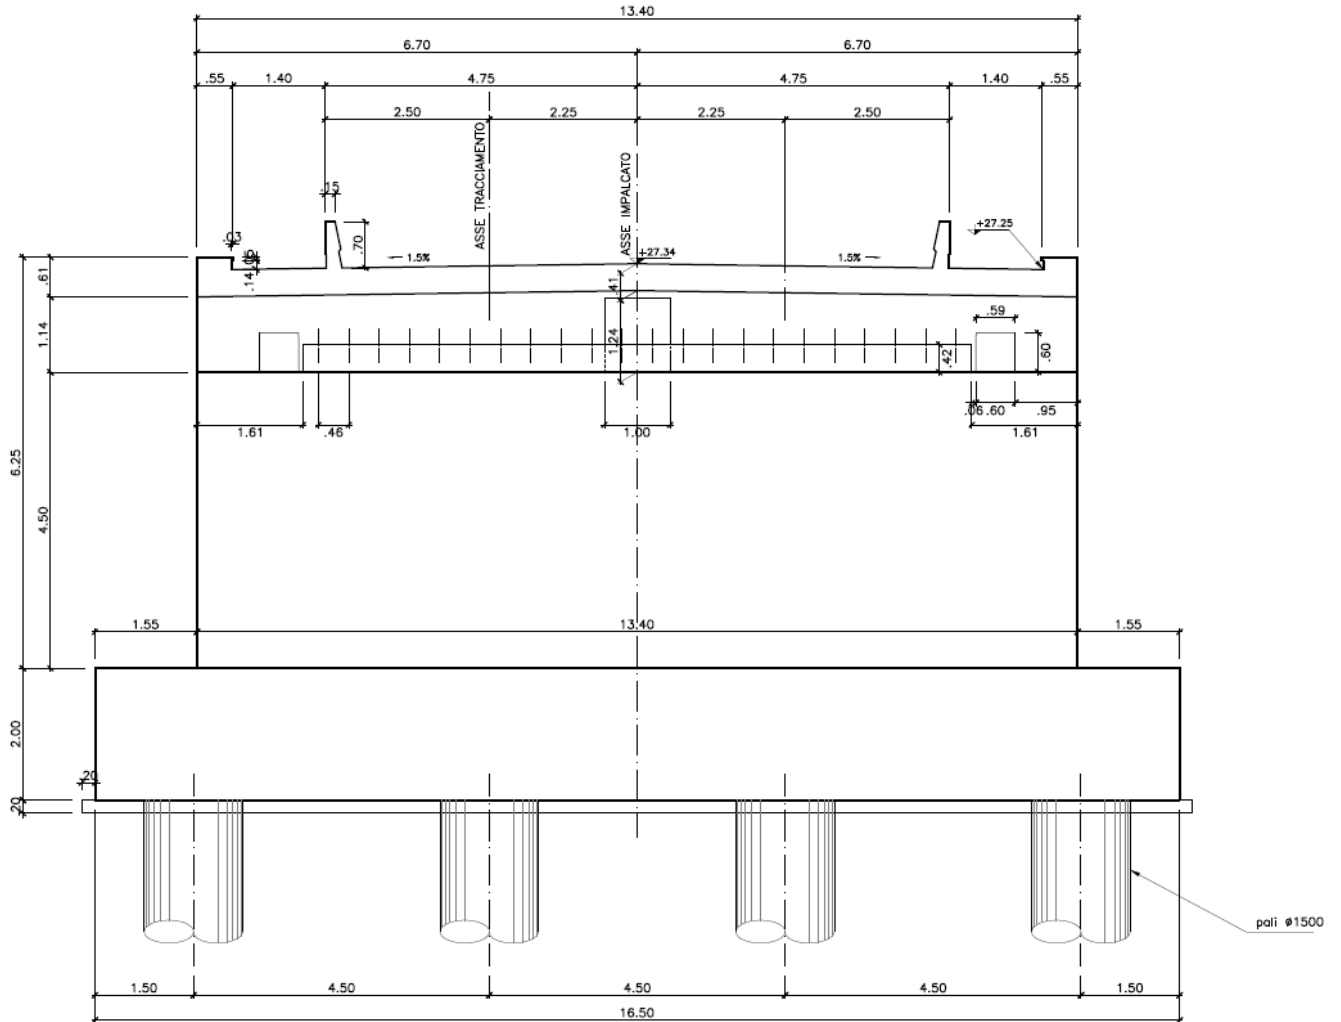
Prospetto frontale Spalla "A".
